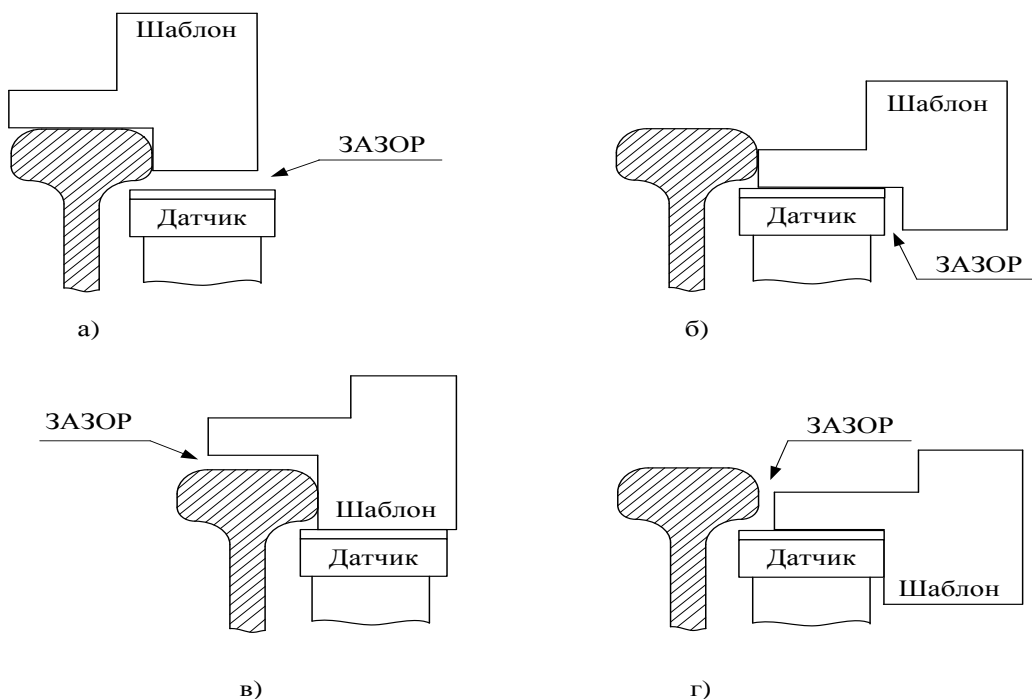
Проверка габаритов установки путевого датчика относительно рельса (а, в – вертикальный габарит; б, г – горизонтальный габарит)
